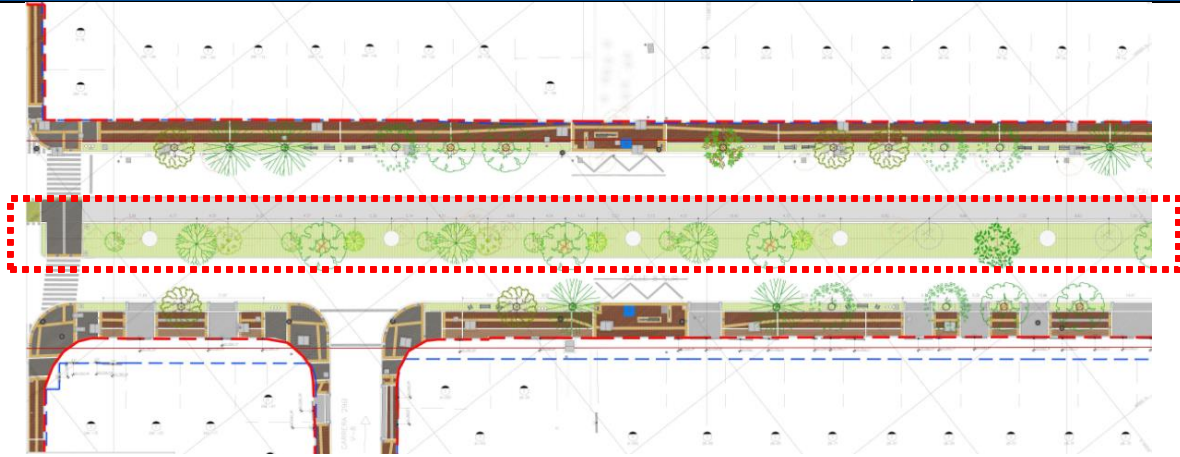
Planta tipología de franja verde bajo el viaducto, interestación 210
